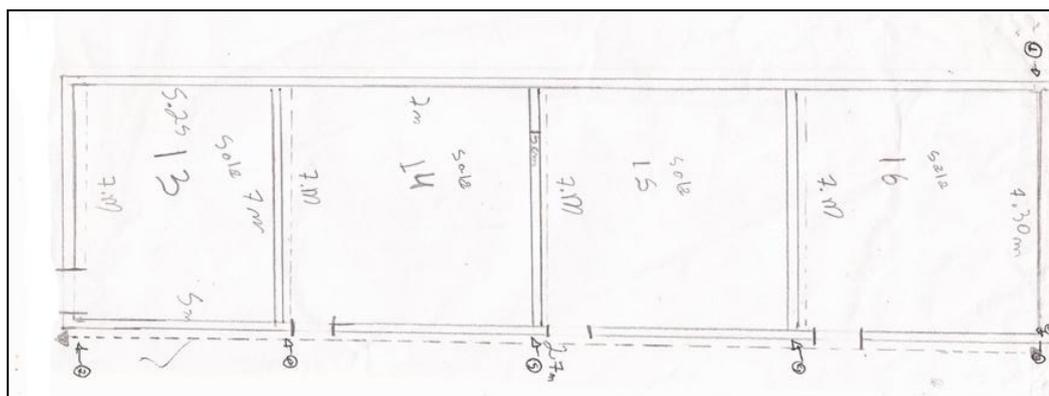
Planta baixa do pavilhão da escola construída pelo aluno 1 do 8º ano A
